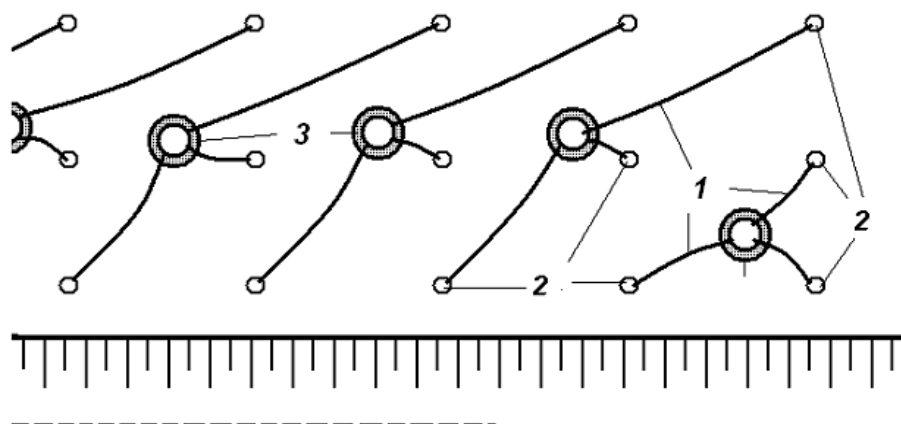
Схема соединения металлических забоек с соединительными элементами
